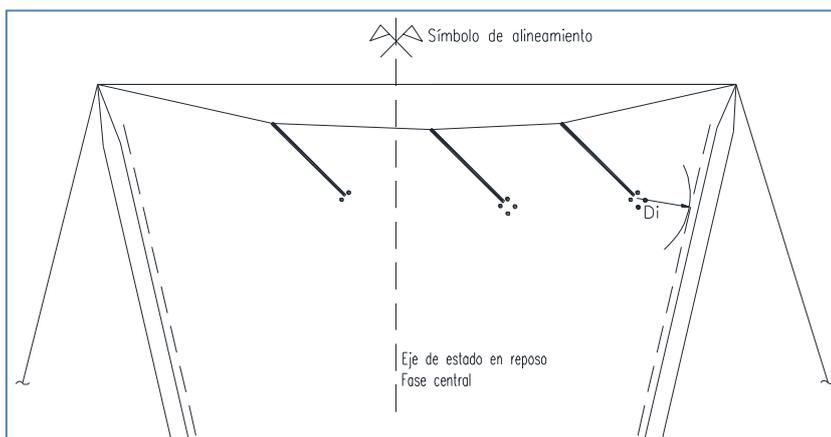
Desplazamiento horizontal de los puntos de apoyo de las cadenas de suspensión, en estructuras tipo cross rope, con viento máximo
